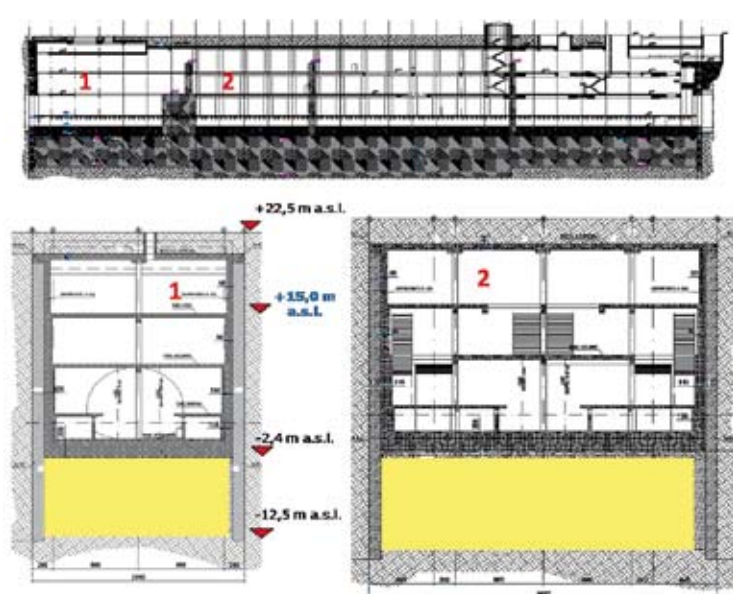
Stazione Conca d'Oro – planimetria e sezione costruttiva
